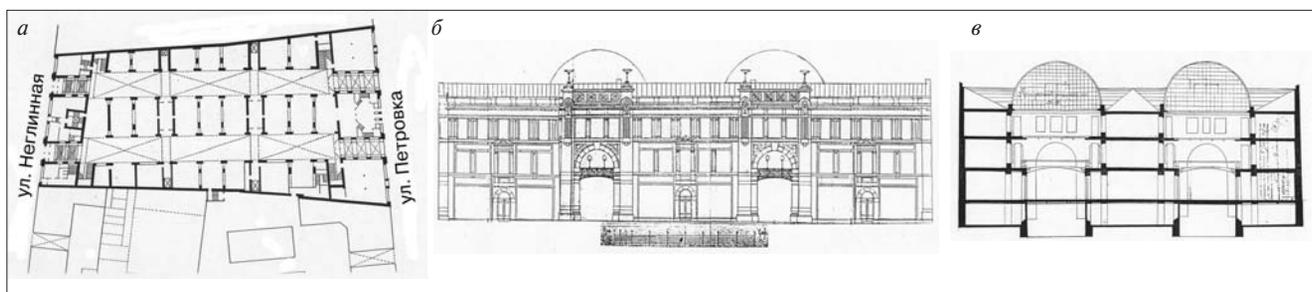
Петровский пассаж: а – план; б – фасад; в – разрез
